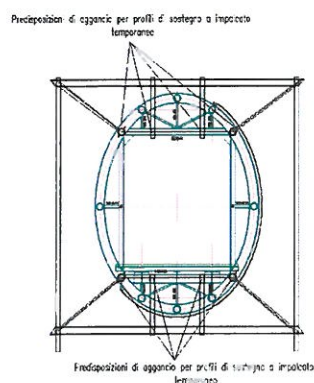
Schema indicativo di predisposizioni per il montaggio di impalcato di servizio
